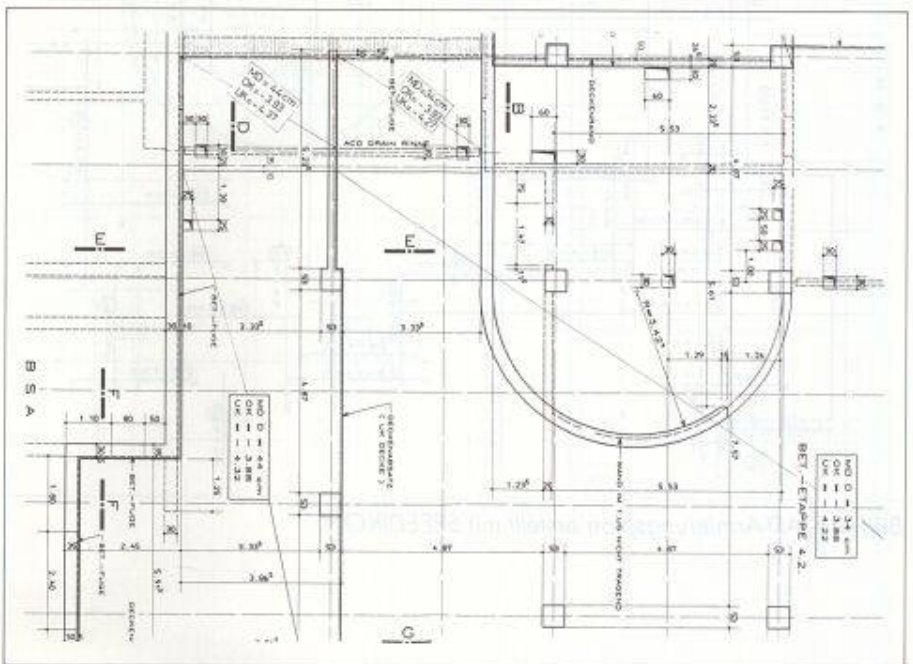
Schalungsplan mit statischem System erstellt mit dem modellorientierten CAD-System SPEEDIKON
